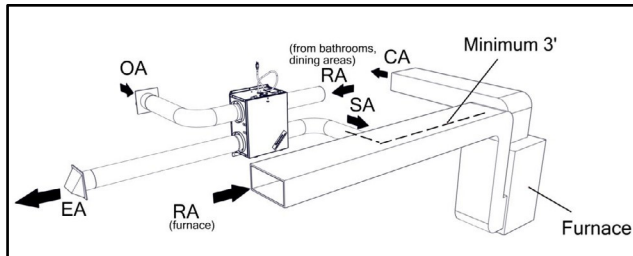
PRISE D'AIR DE RETOUR SÉPARÉE — ALIMENTATION EN AIR DE LA CHAUFFE-EAU CONDUITE D'AIR DE RETOUR
